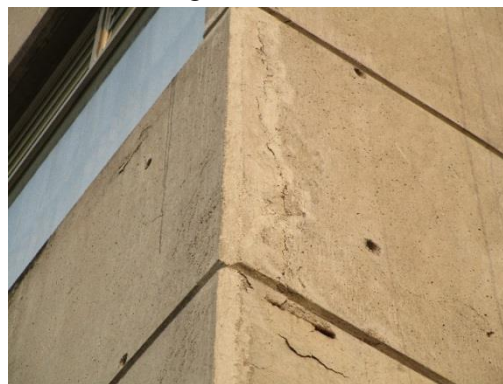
Fisuras en muro. Foto 10.
